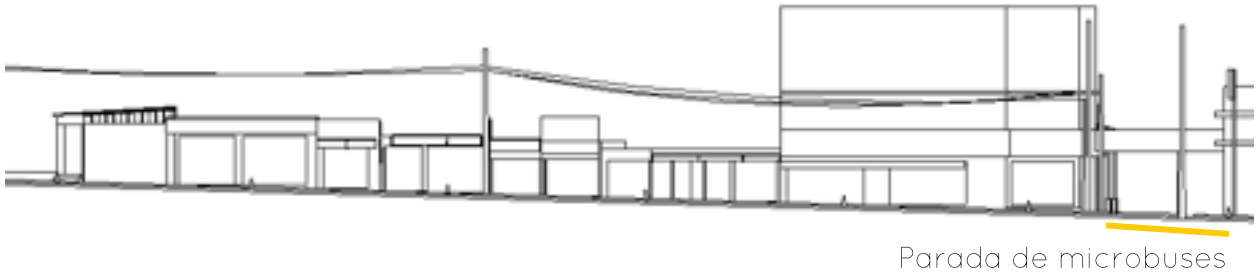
Extracción de formas 1ra avenida entre 1ra y 2da calle fachada Este
